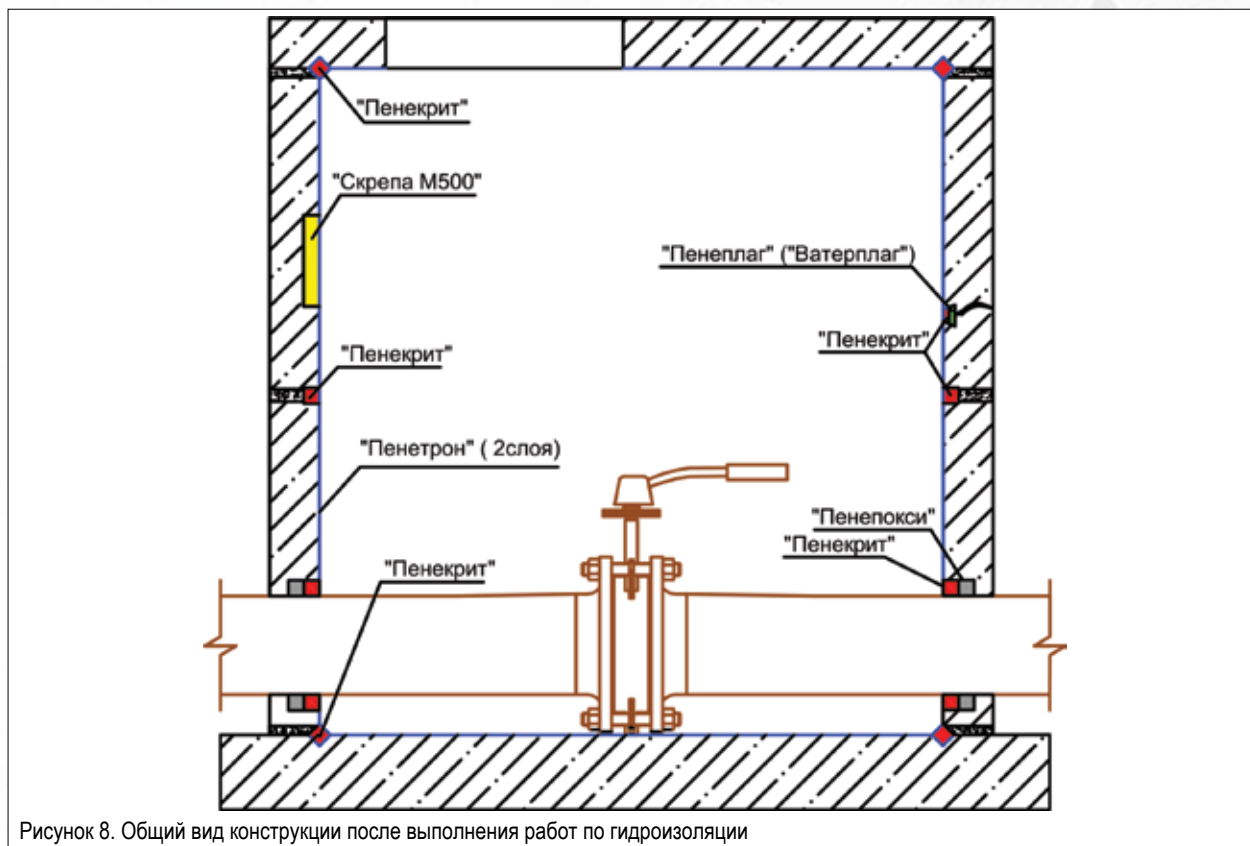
Общий вид конструкции после выполнения работ по гидроизоляции
